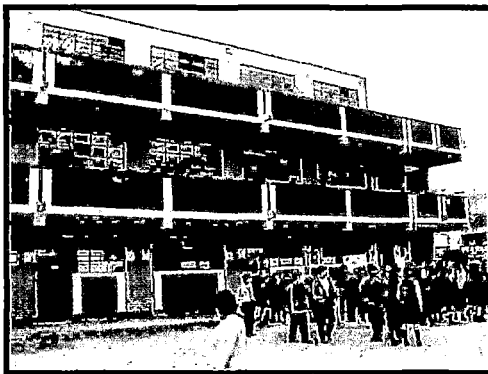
CE Mujeres del Rímac, estructuración tipo H
